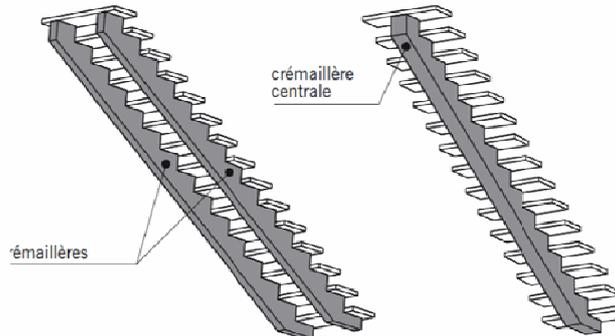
Escaliers préfabriqués avec crémaillères en béton.
